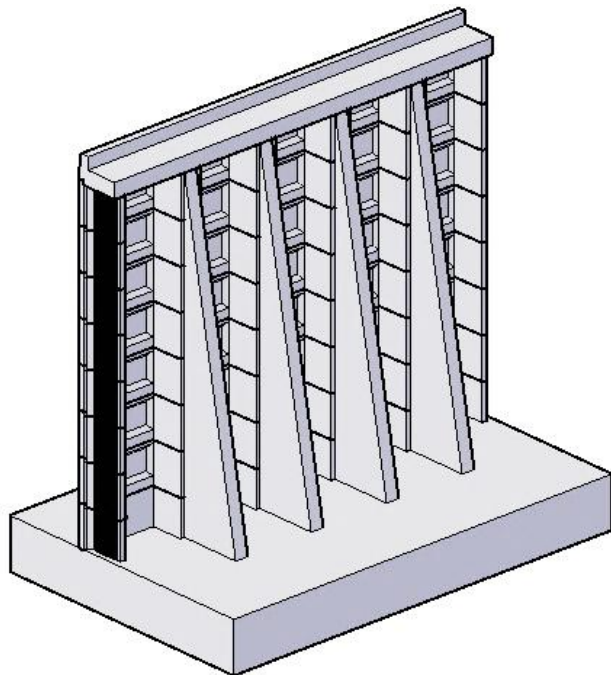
Vista 3D muro $H=8,0m$ con paneles rectos (Interior)
